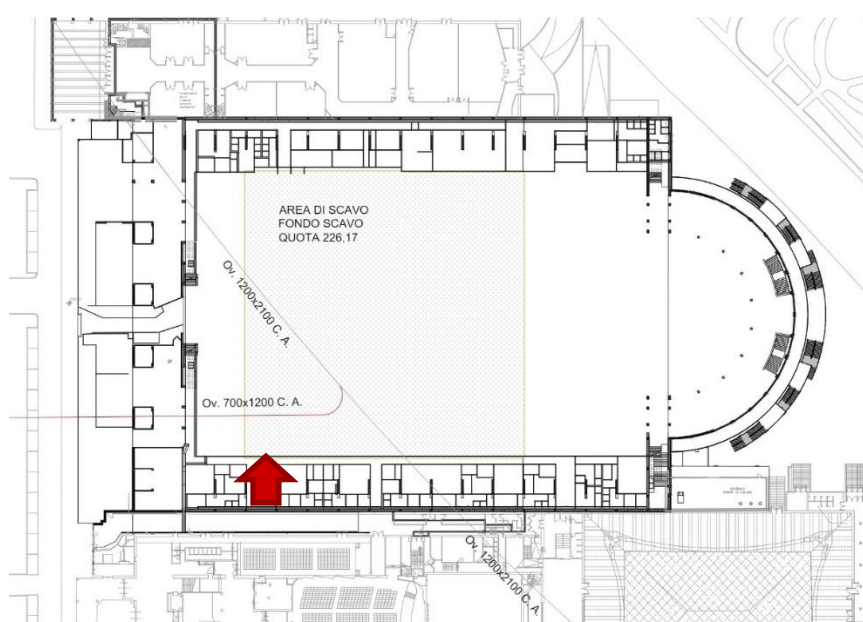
Planimetria rete fognaria – nera profonda e innesto interferente
